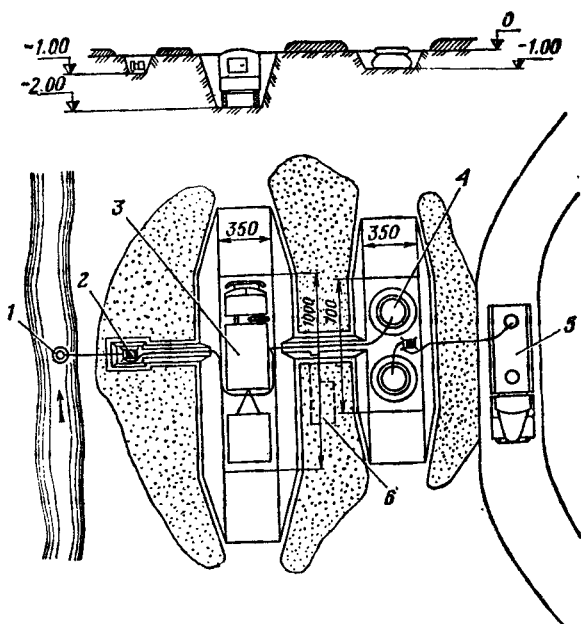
Пункт водоснабжения на войсковой фильтровальной станции ВФС-2,5 (вариант):
